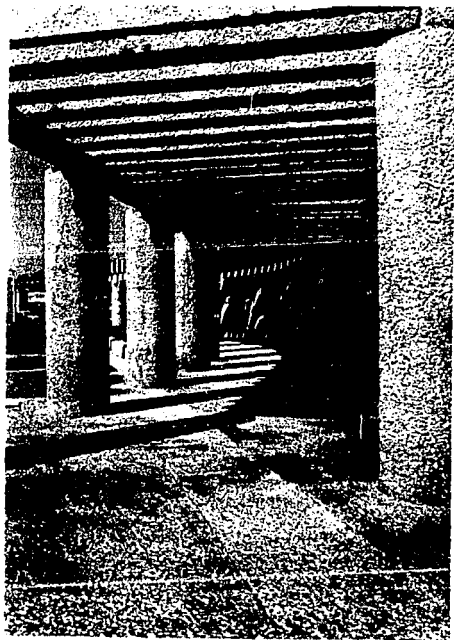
Plaza Rufino Tamayo. Arq. Teodoro Gonzalez de León(1993). Se usó concreto arquitectónico aparente en piso, muros, columnas y pergolas.
